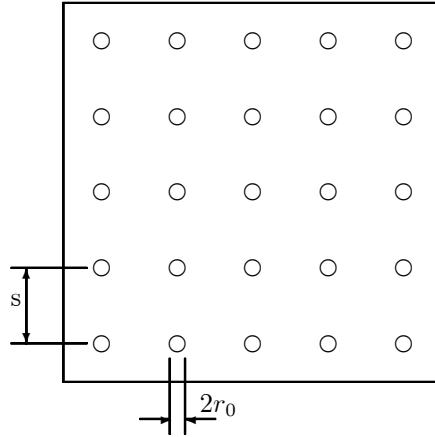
Planta de la cimentación del ejemplo de aplicación.
